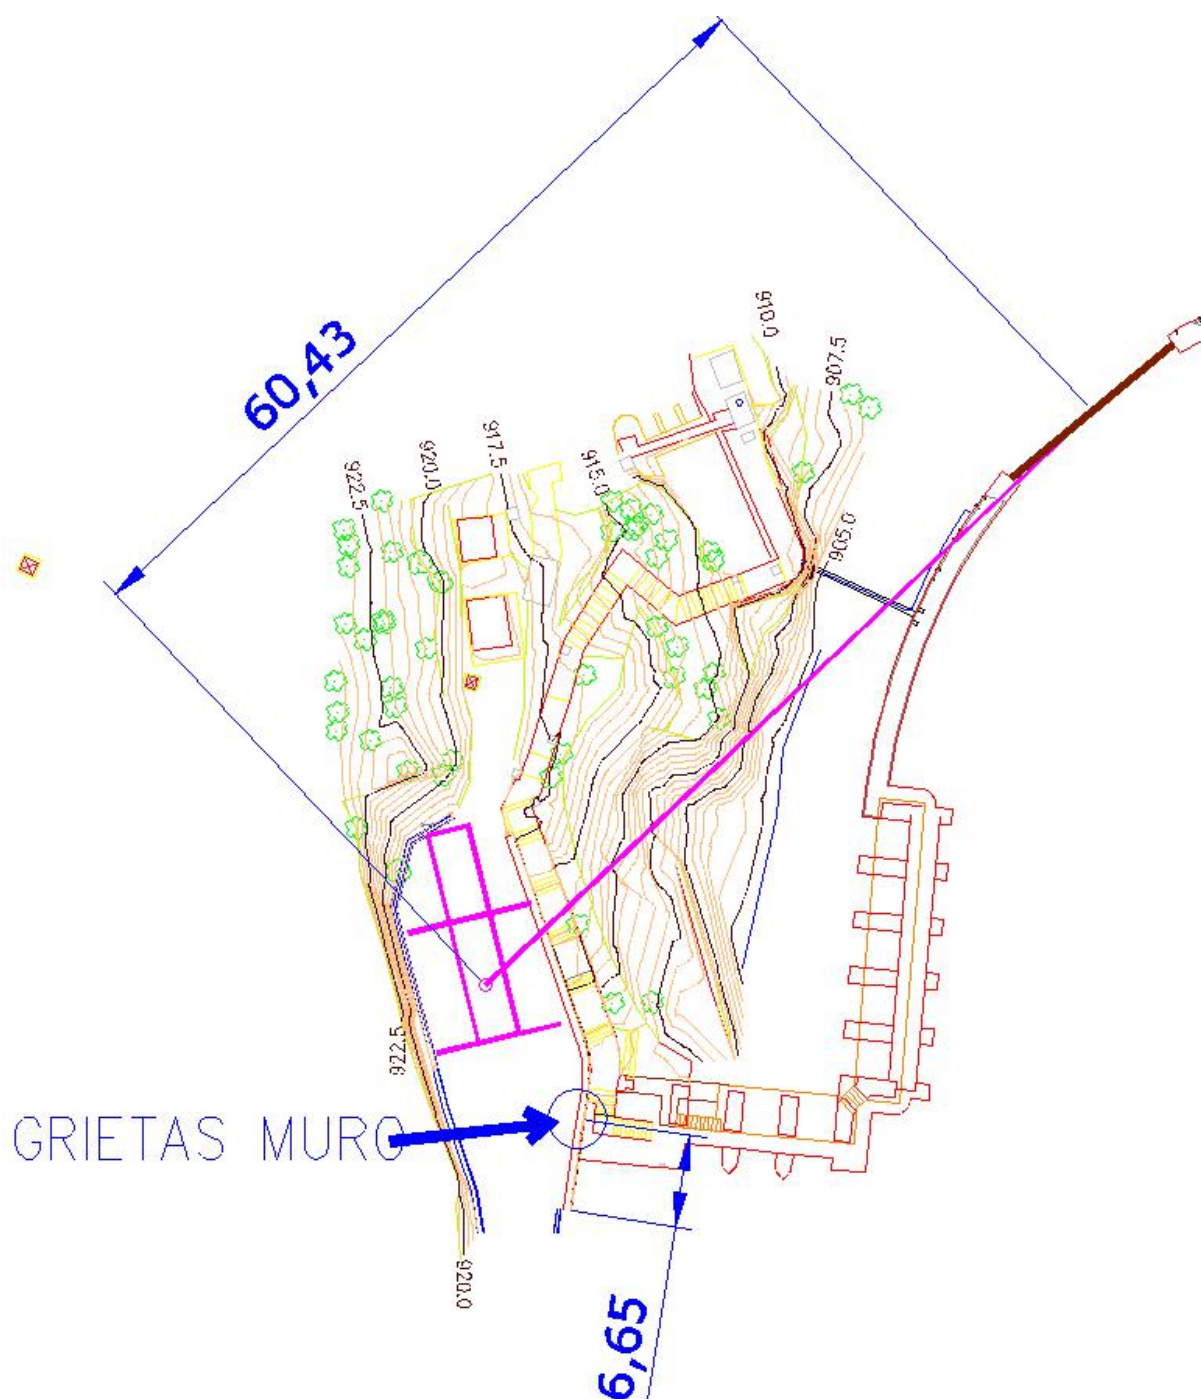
Plano de planta de la zona del azud. Se identifica la plataforma y se muestra esquemáticamente el posicionamiento de la grúa en ella, junto con el alcance del brazo. También se indica la existencia de una grieta en el muro de contención de la plataforma, acotando su localización desde el inicio de éste.
